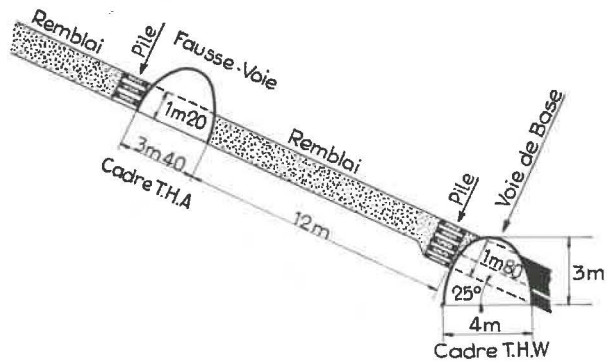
Coupe du pied de taille avec fausse-voie cadré et mur de remblai.
